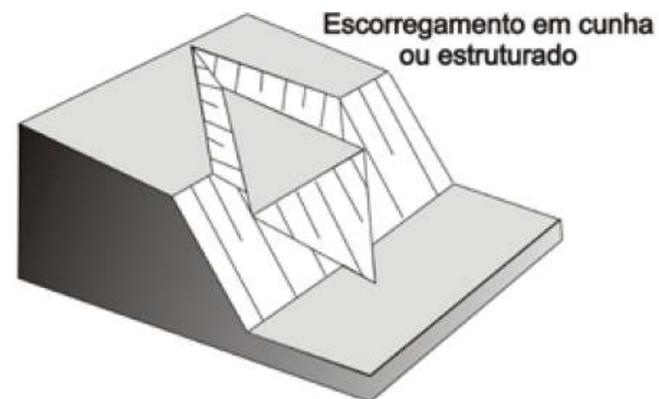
Perfil esquemático de escorregamento em cunha ou estruturado
